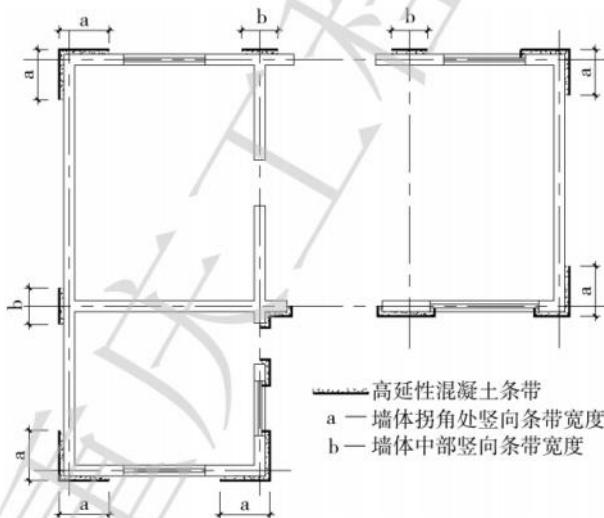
高延性混凝土竖向条带设置平面示意图
